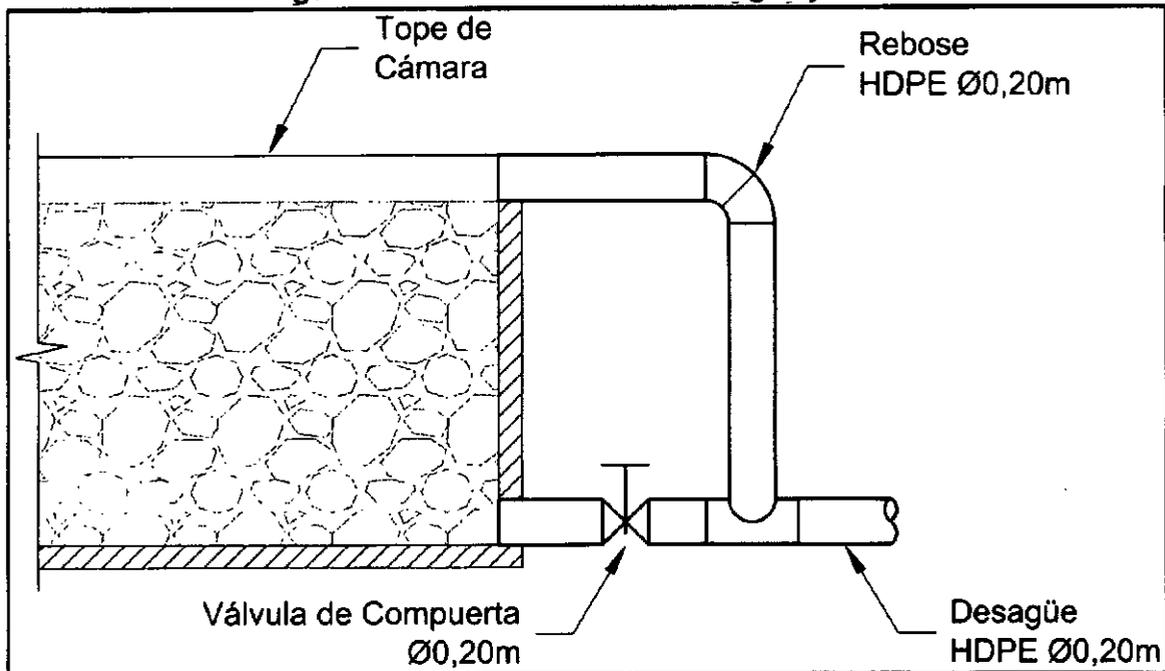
Planta Cámara de Tratamiento Pasivo.
